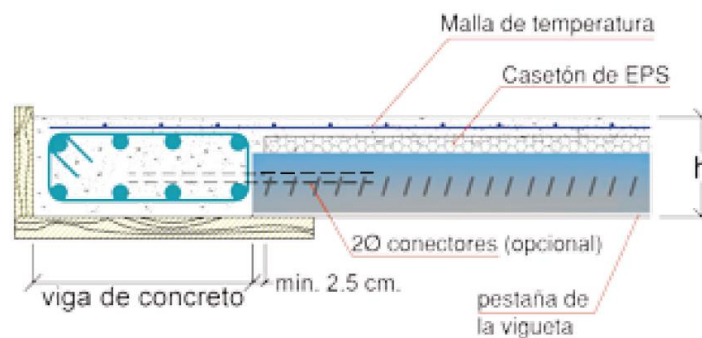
Detalle constructivo de encuentro con viga chata exterior
